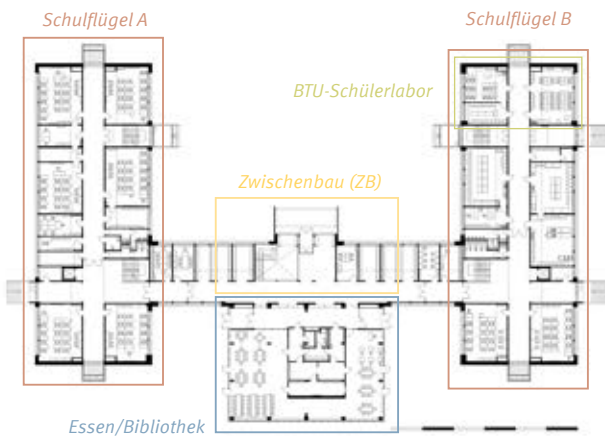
Grundriss des Max-Steenbeck-Gymnasiums
